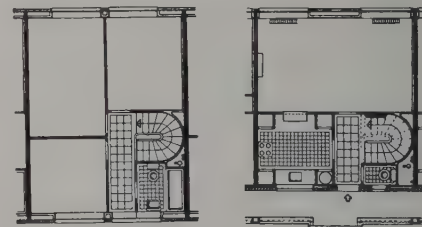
Grundriß der zweigeschossigen Laubengangwohnungen zu Abb. 28. Querwandtyp, 6,25 m Achsmaß. Tragende Wände Gußbeton bewehrt, durch alle Geschosse 15 cm dick, Decken Ortbeton, 20 cm dick. Die vorgefertigten Fassadenplatten bestehen aus einer äußeren 11 cm dicken Betonplatte, 19,5 cm Luftzwischenraum und einer 7,5 cm dicken Innenwandplatte. Die Giebelwände sind als Fournierbeton zwischen den vorgefertigten Paneelplatten ausgebildet und nach innen mit einer Paneelplatte mit Luftzwischenraum verblendet
